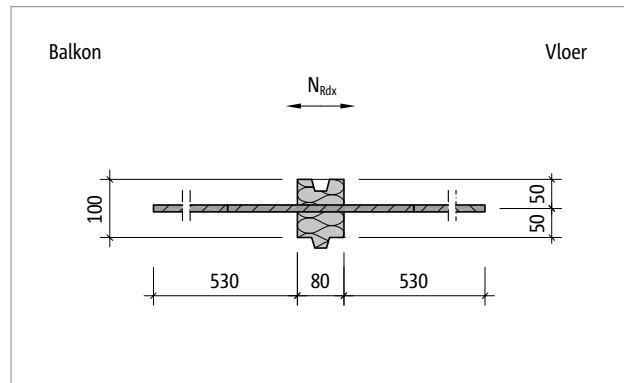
Schöck Isokorf® T type H-NN1: Zijaanzicht
